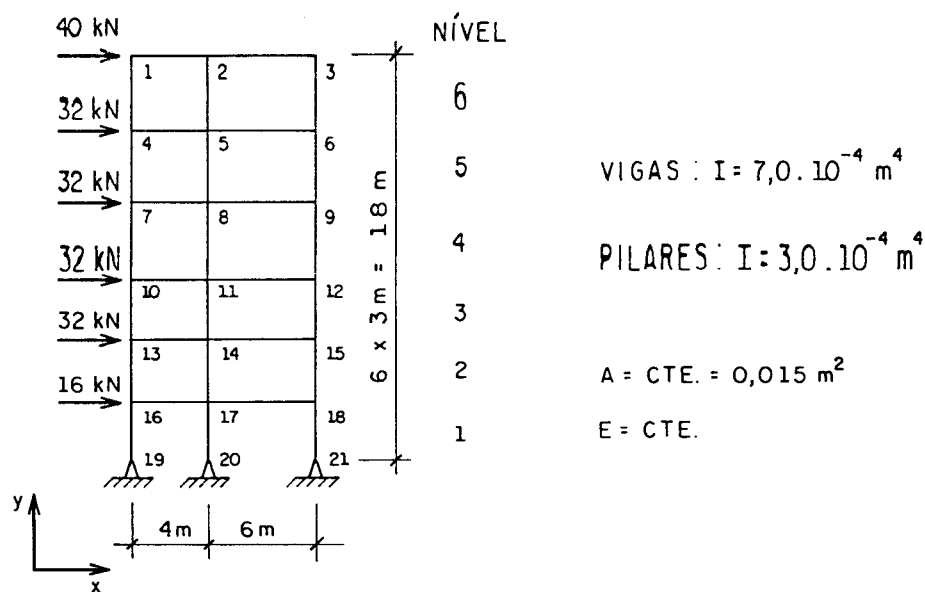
Pórtico plano submetido a ações horizontais
